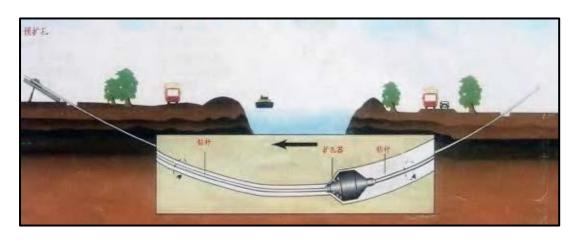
定向钻穿越施工预扩孔过程断面示意图
